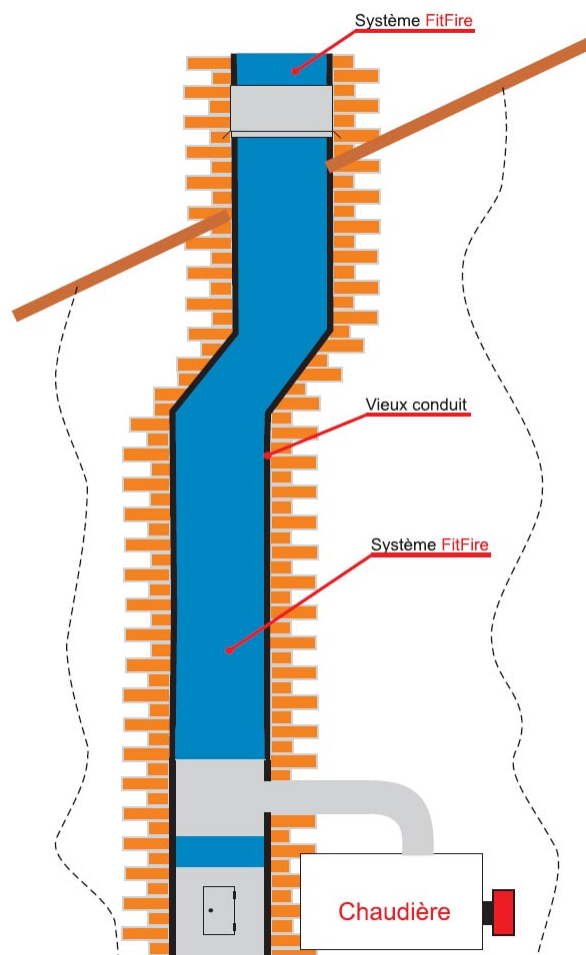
Mise en œuvre de la chaussette FITFIRE en rénovation de conduit individuel existant en configuration de chemisage
